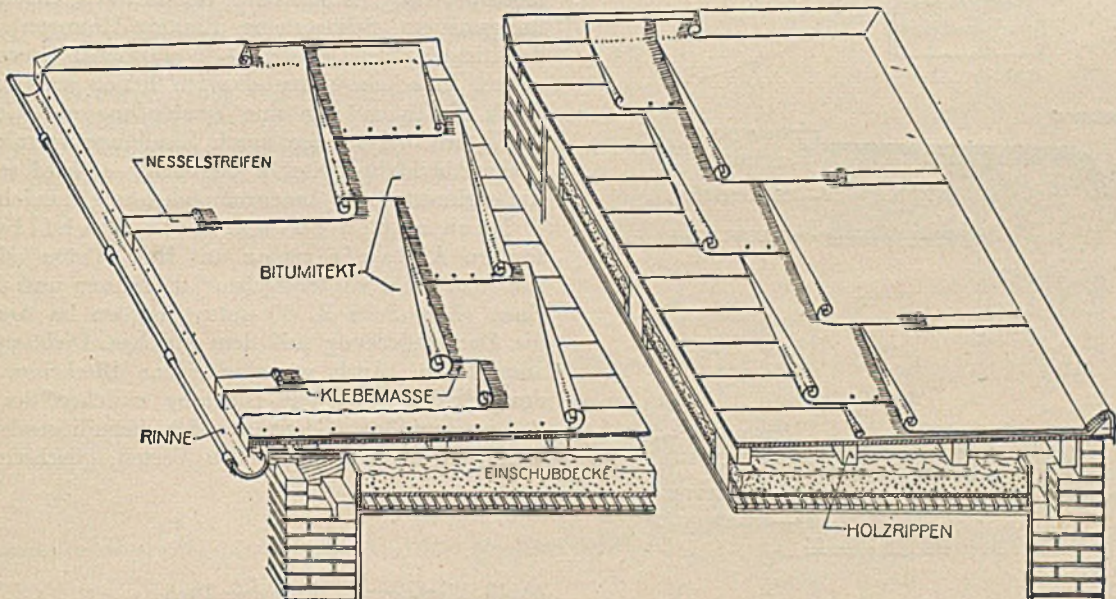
Pappdach auf Holzschalung über Holzbalkendecke
